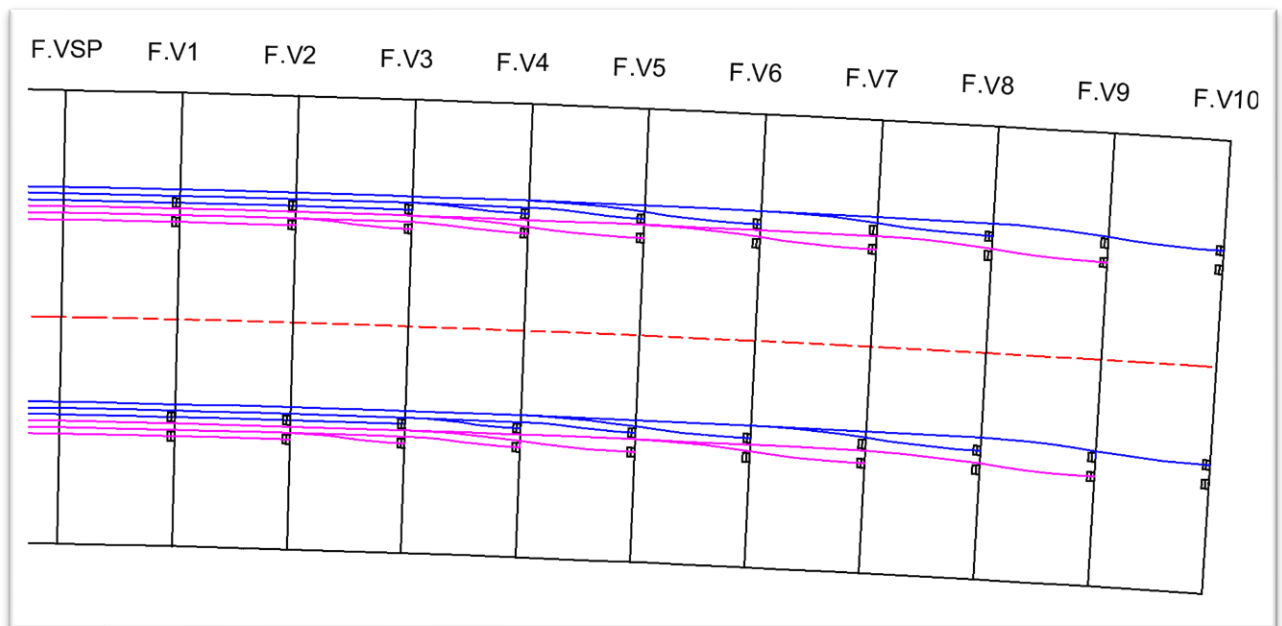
Schema de trace en plan des câbles de demi-fléau.
